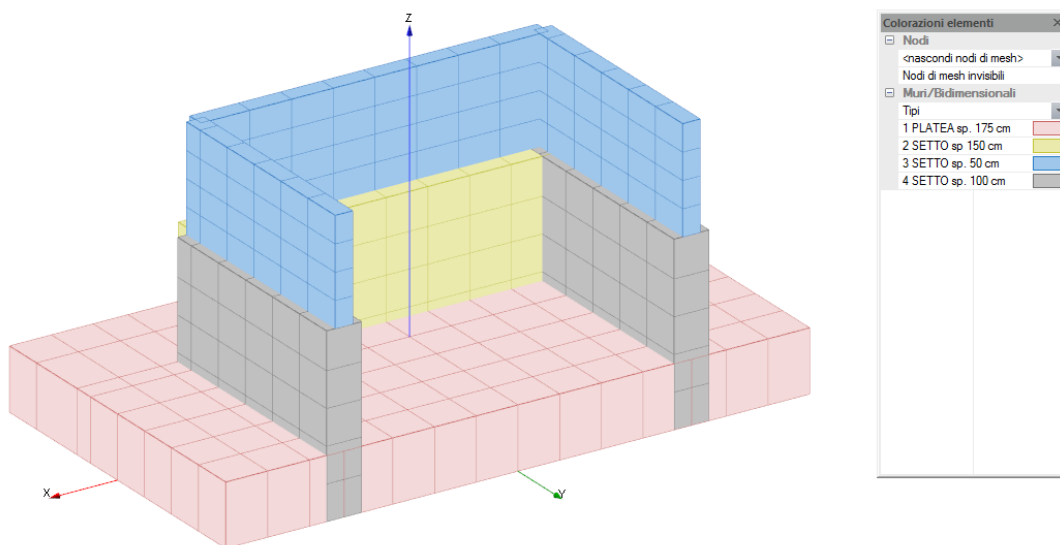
VISTA TRIDIMENSIONALE SOLIDA MODELLO SPALLA 1 – LATO MONTE
